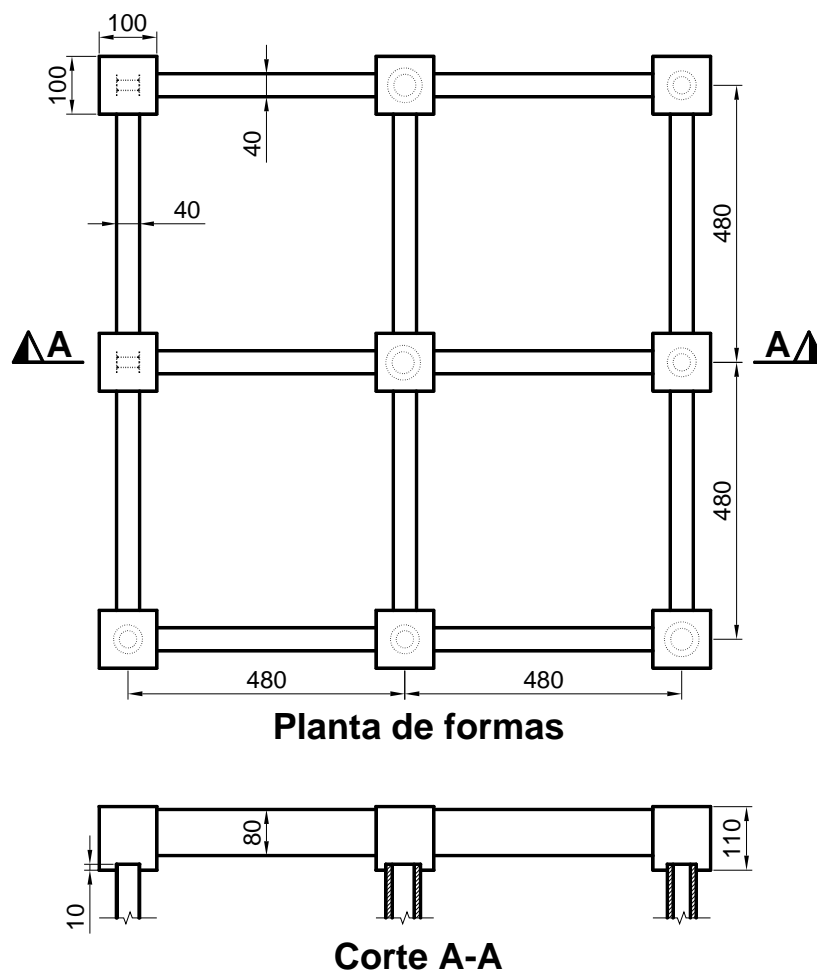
Planta de formas da estrutura de travamento das cabeças das estacas (dimensões em centímetros)
